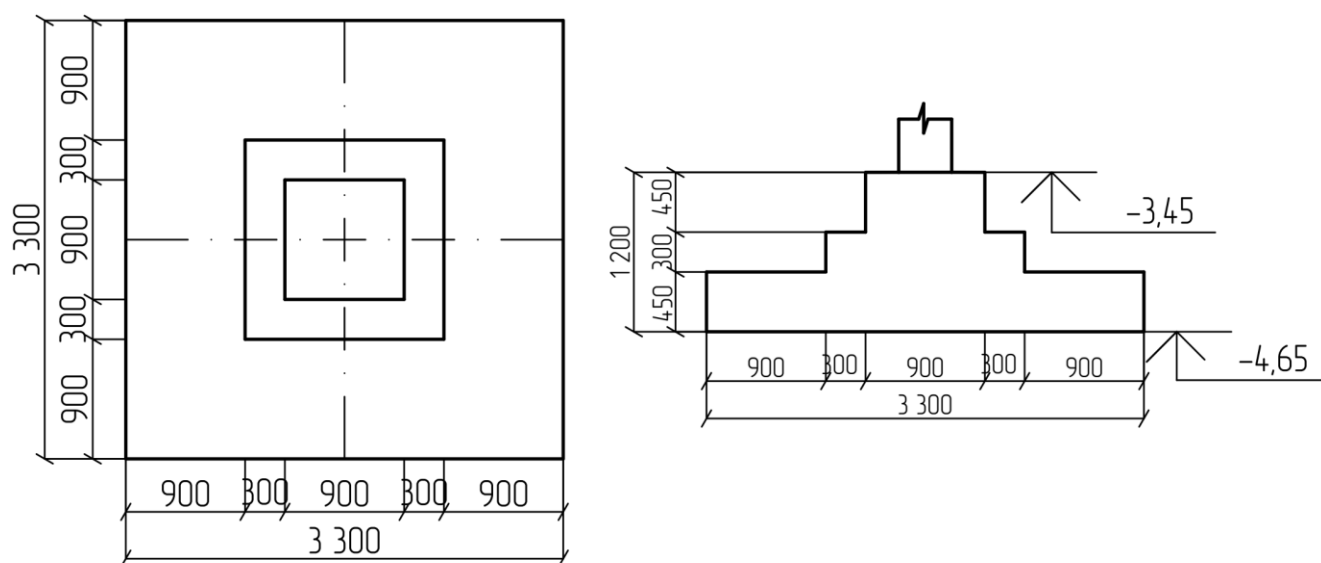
Конструктивне рішення фундаменту мілкого закладання
